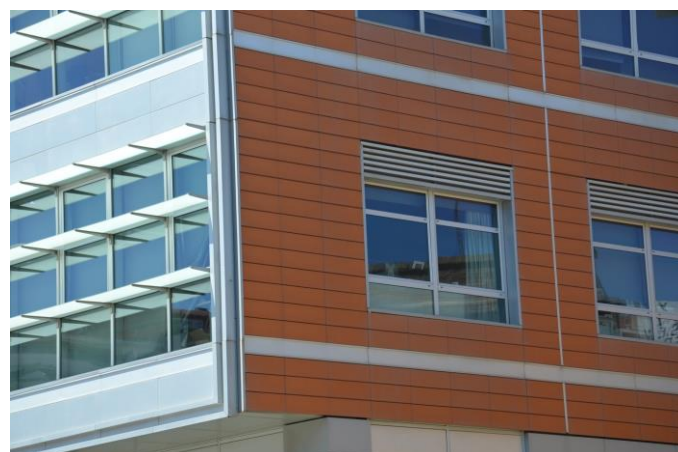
Detalles de los perfiles en aluminio de la estructura que dificultan (si no impiden) el paso del aire dentro de la cámara). Foto de la autora.
